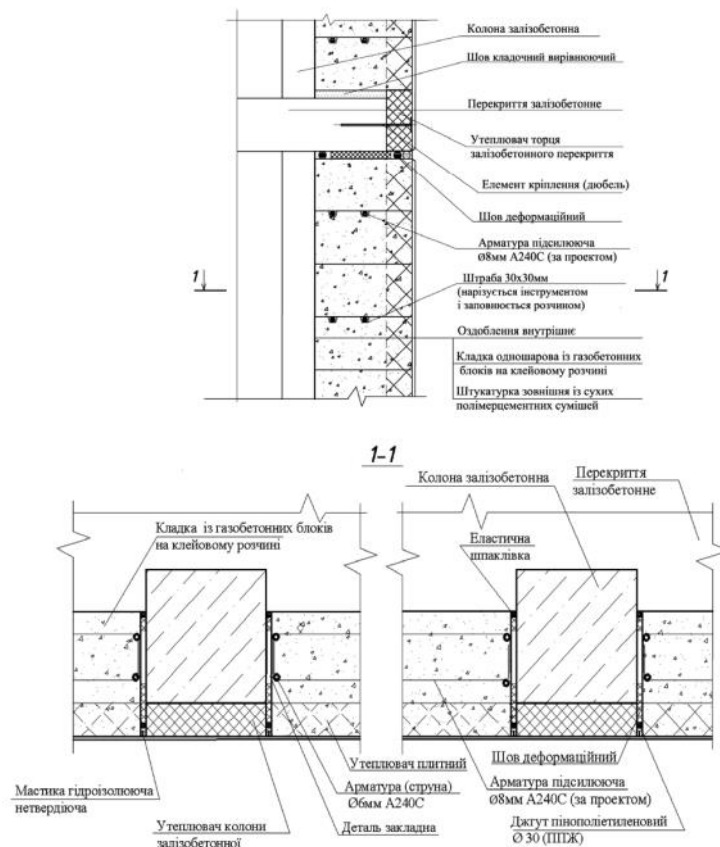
Стіна зовнішня одношарова із газобетонних блоків
